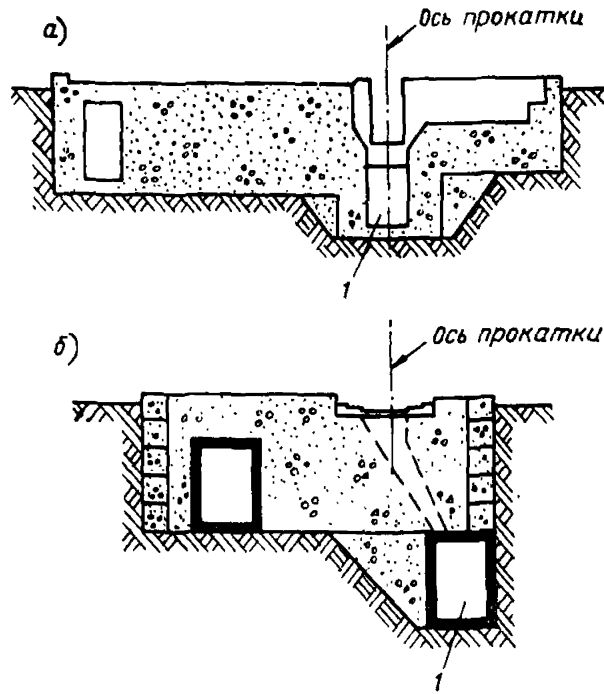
Массивные фундаменты под основное оборудование (рабочие клетки)
